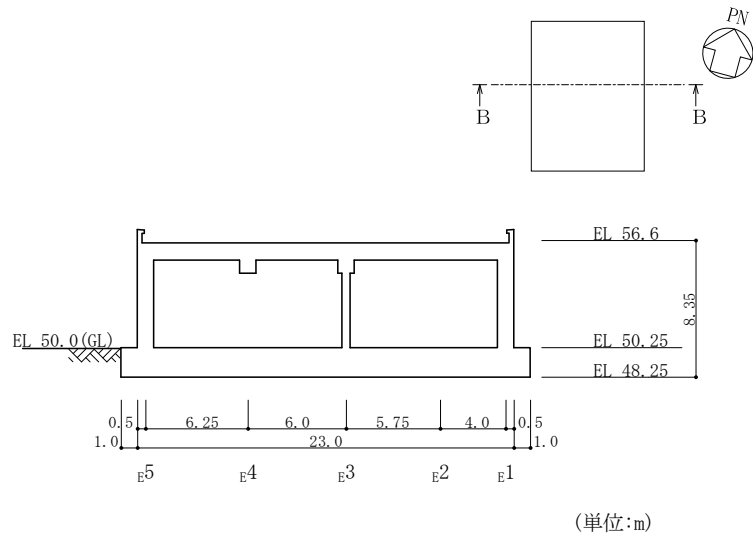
(2) 緊急時対策所の概略断面図 (B-B 断面, EW 方向)
